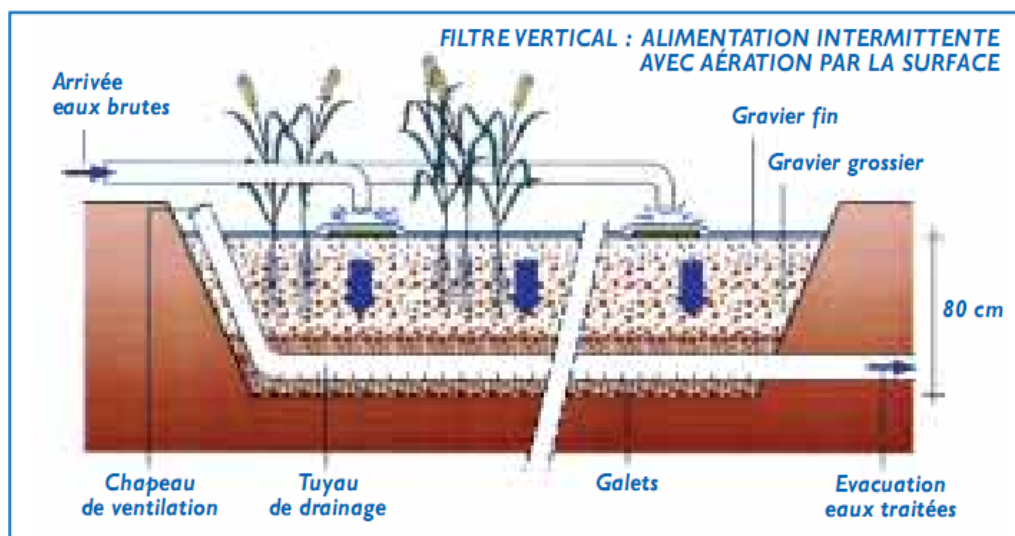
Coupe transversale d'un filtre planté à écoulement vertical
